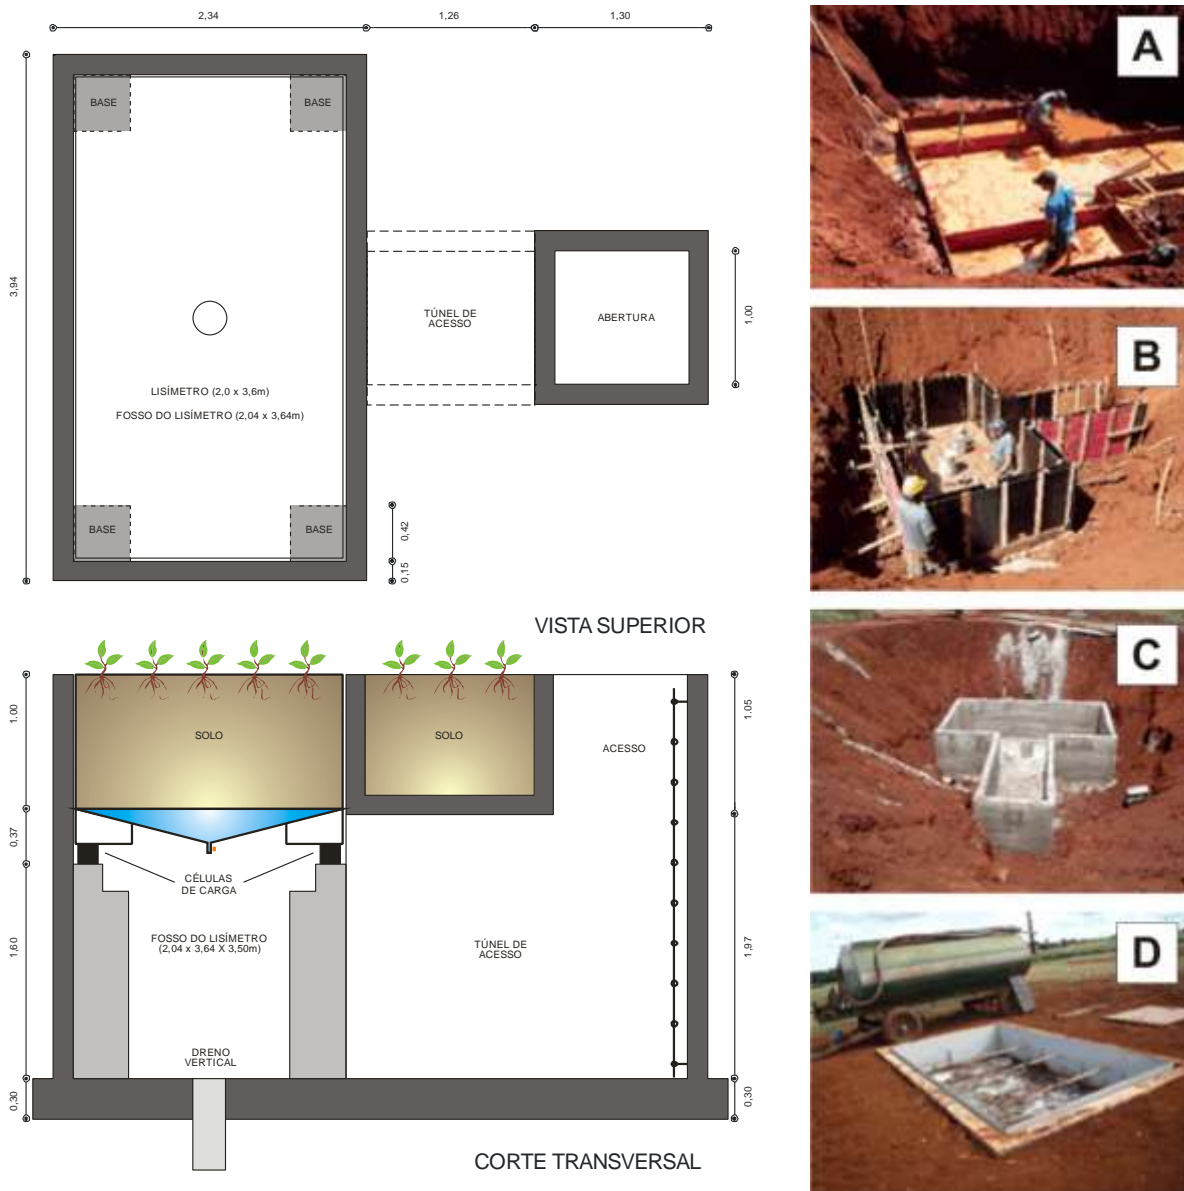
Diagrama esquemático do segundo conjunto lisimétrico (4 a 6) e detalhes do processo de construção (A, B e C) e do preenchimento da caixa metálica com solo (D)
